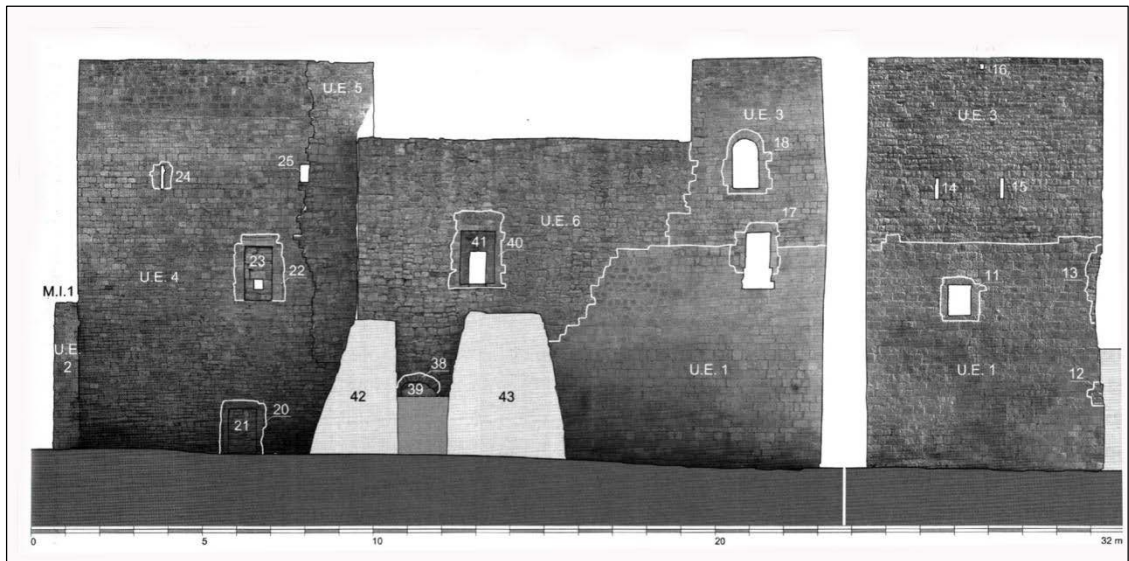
Modugno, Balsignano. Castello e prospetto con lettura stratigrafica degli elevati. (Castagnolo 2006, fig. 19).
